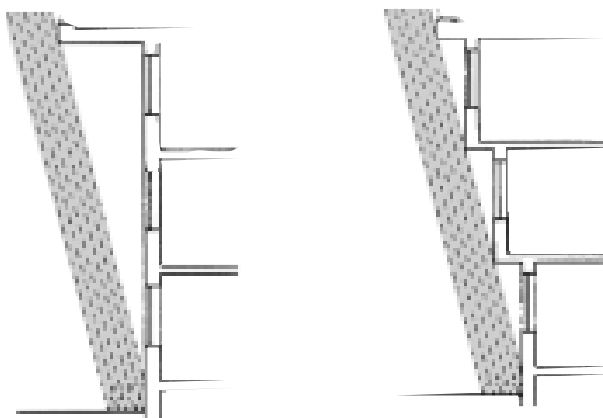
protezione della facciata dalla pioggia attraverso una gronda sufficientemente sporgente o attraverso l'arretramento dei diversi piani
